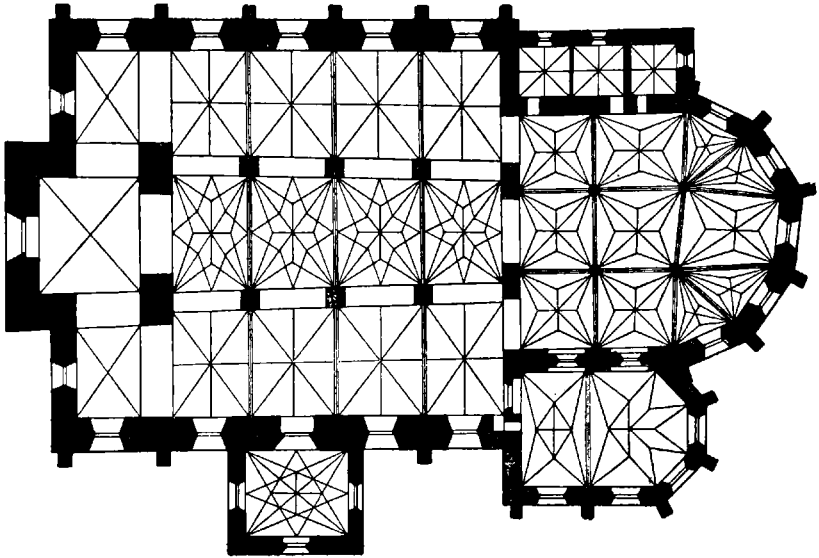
Grundriss der Olaikirche. Nach V a g a Eesti kunstiajalugu.
